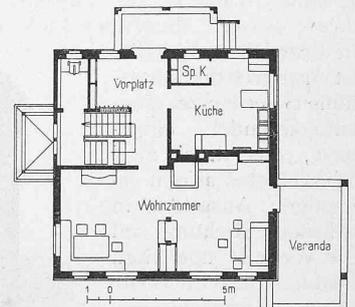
Grundriss vom Erdgeschoss des Hauses von Dr. Finckh. — 1 : 400.
